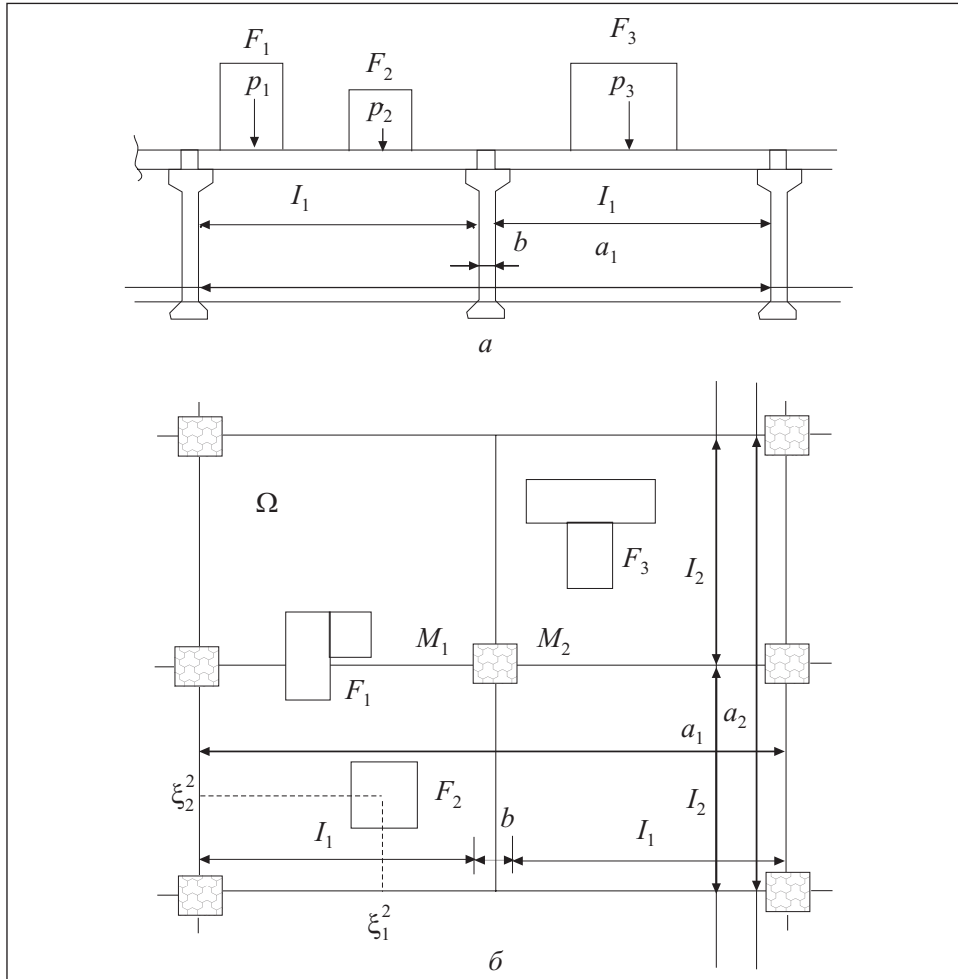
Схема размещения временных нагрузок на покрытие (а) и пример допустимого размещения нагрузок (б)
